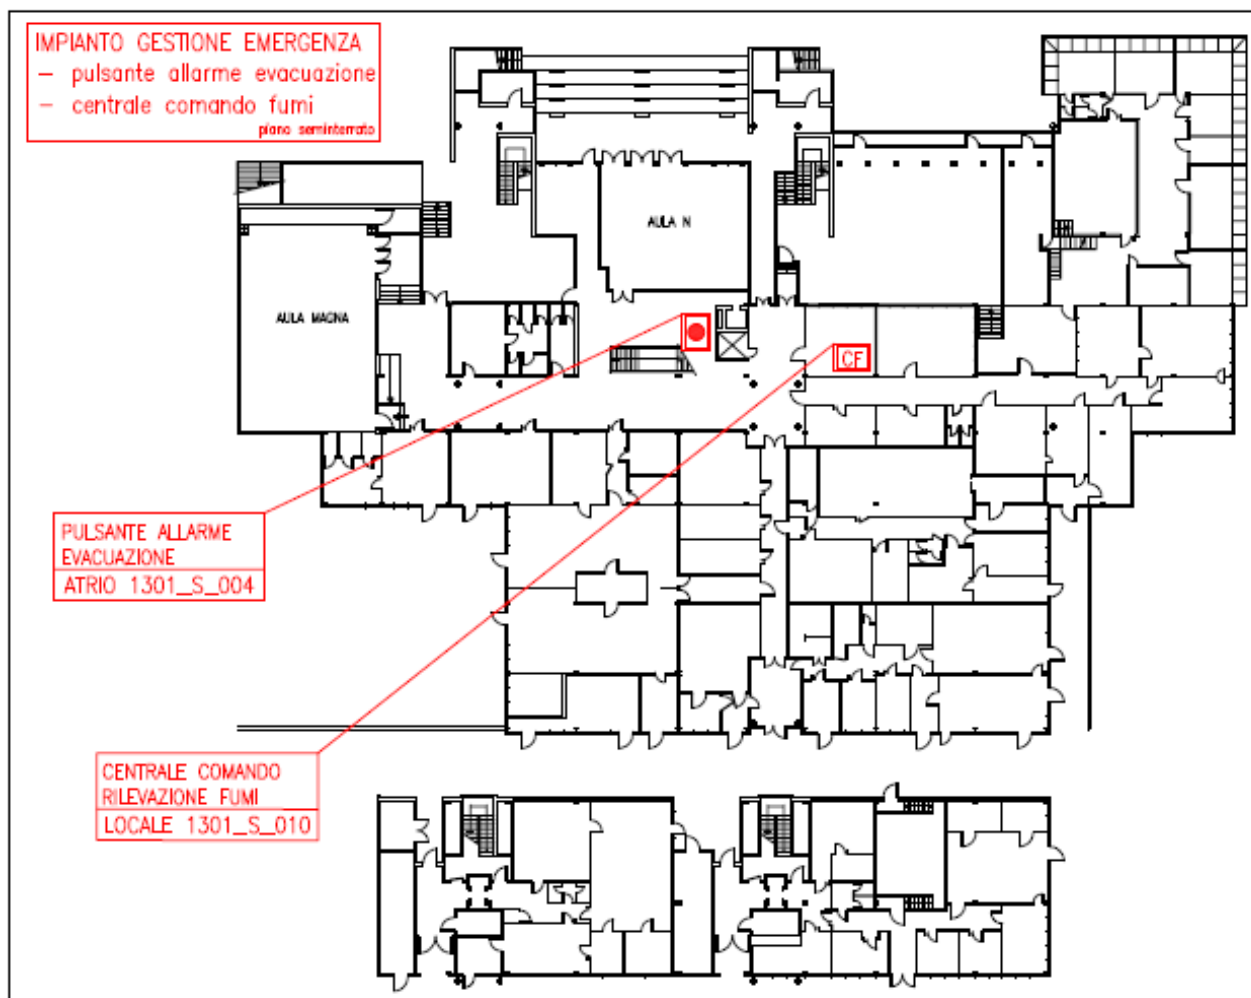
Ubicazione del pulsante di evacuazione (suono continuo della campana) e della centrale di rilevazione fumi – Stralcio delle planimetrie di emergenza.
